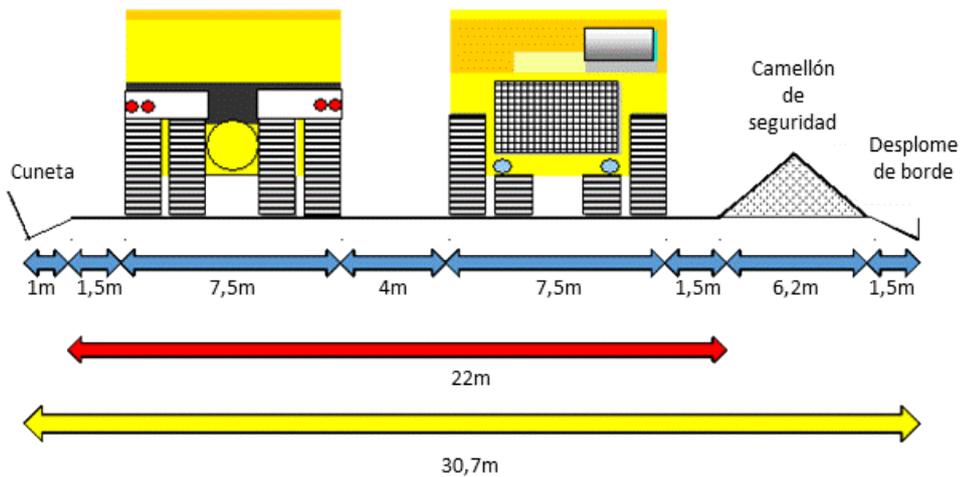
Ancho de camino de 2 pistas sin camellón central
